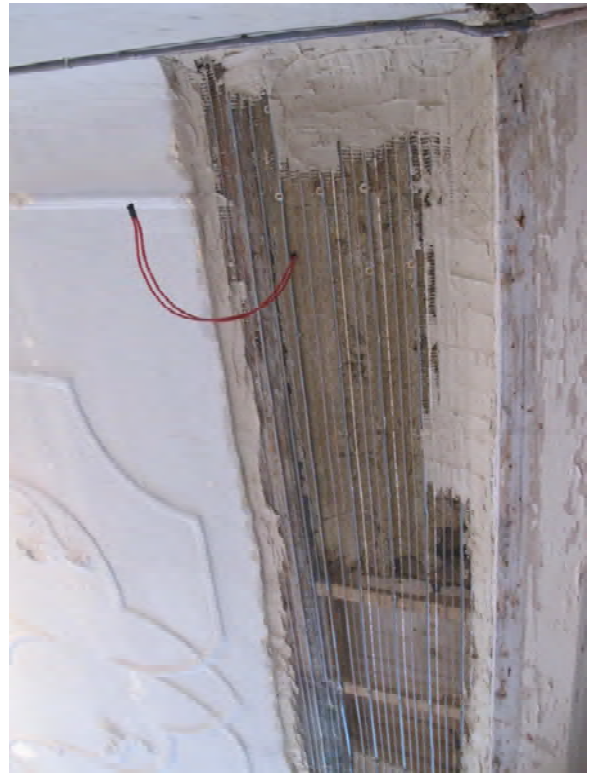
Raum 2.04, Decke; Zustand vor Restaurierung.
